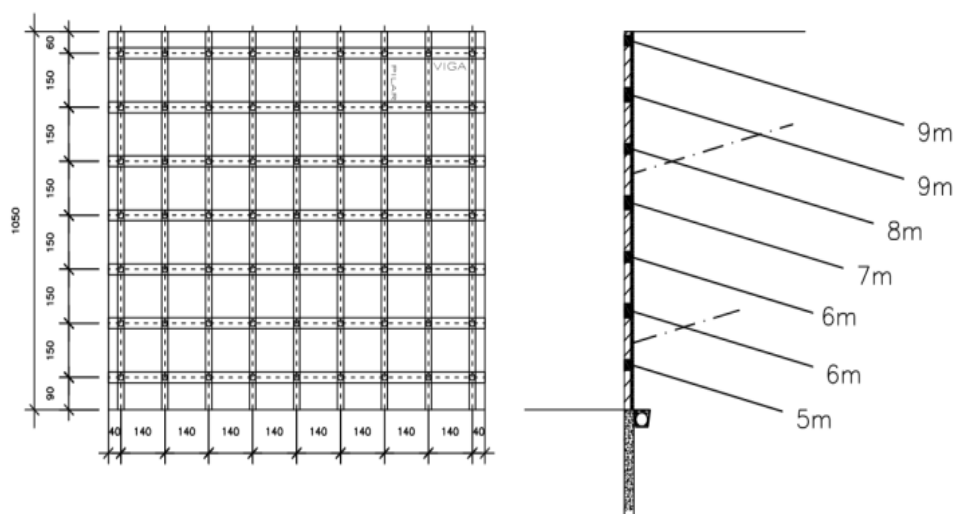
Vista Frontal e Corte do muro a ser executado. Fonte: Os autores.
